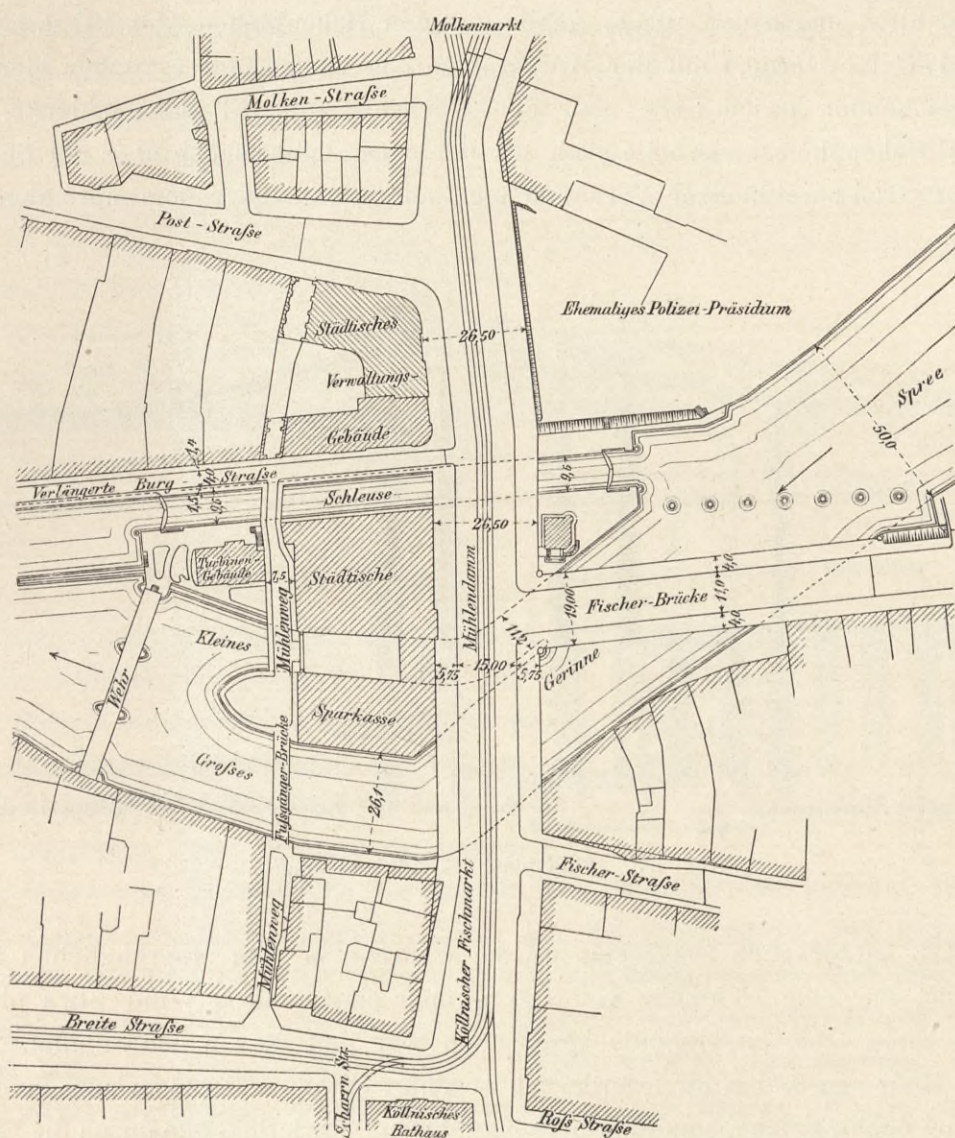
Lageplan des Mühlendamms nach dem Umbau.
